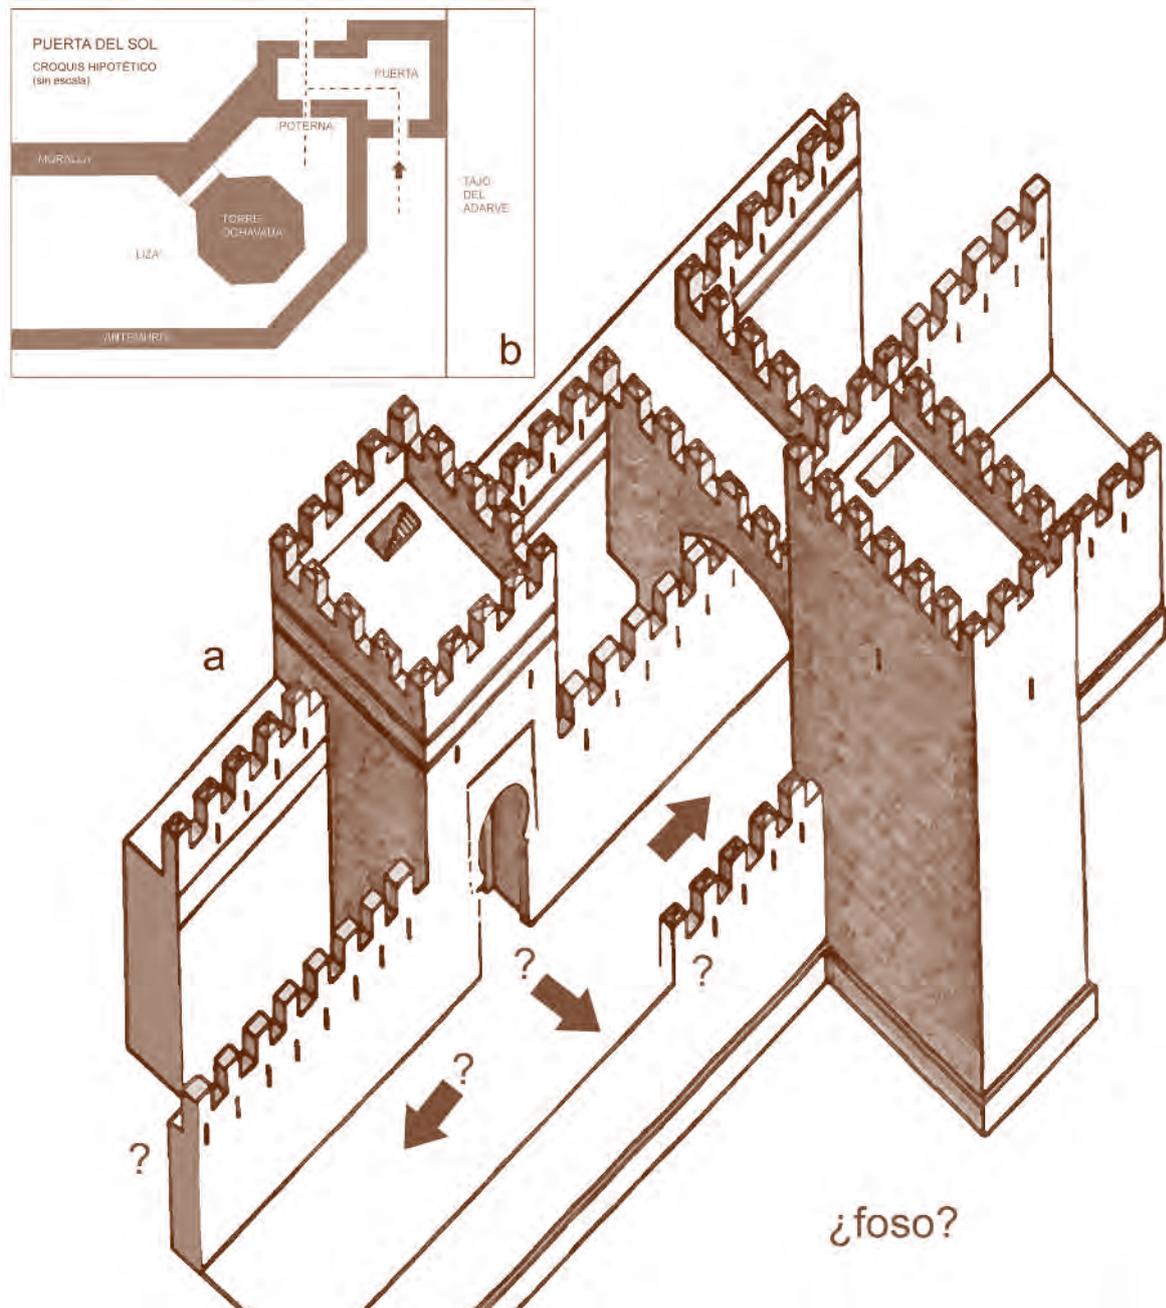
Reconstrucción ideal de la Puerta de Santa Ana (siglos X al XIV), según las excavaciones arqueológicas realizadas (a) y croquis hipotético esquemático de la planta de la Puerta del Sol (b).
